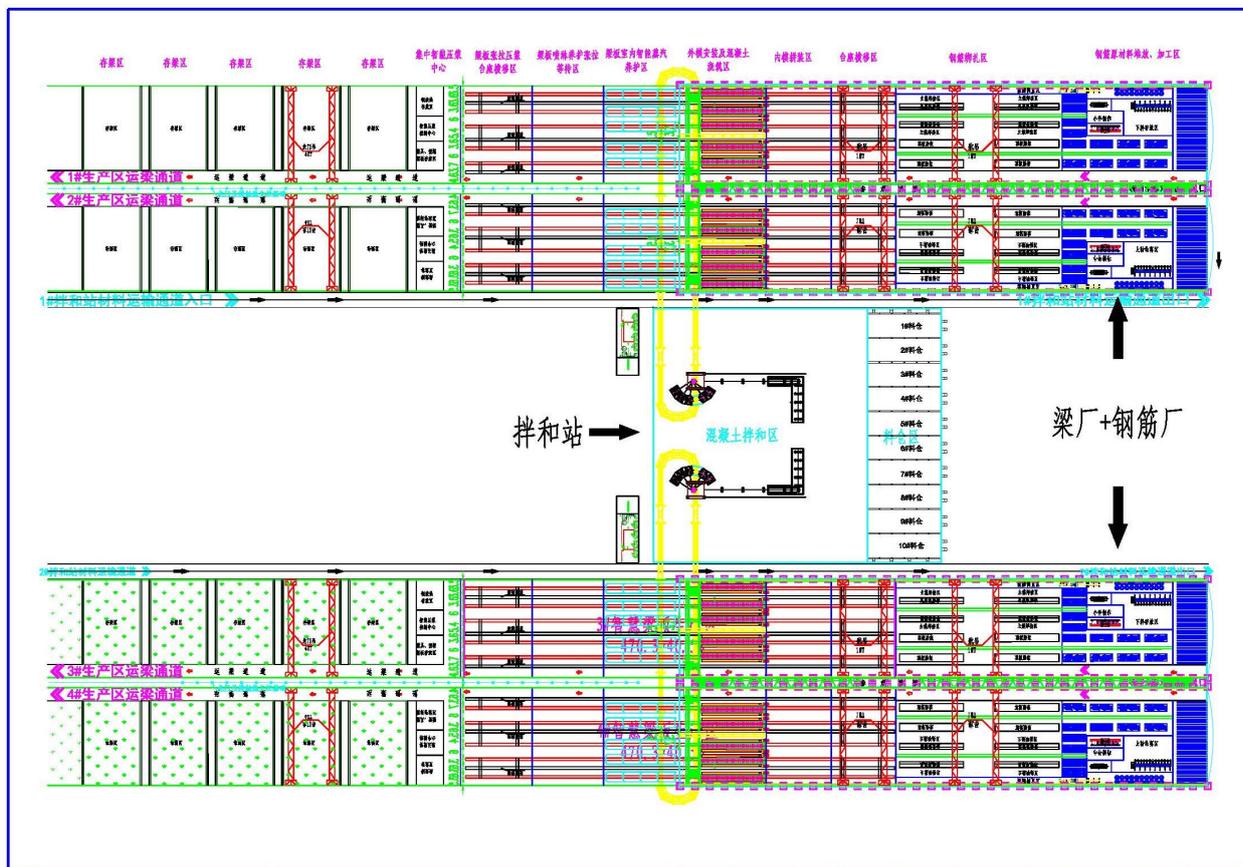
智慧梁厂、拌和站及钢筋厂三者布置示意图
